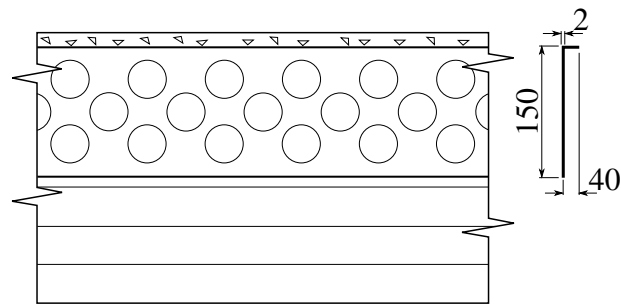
Connecteur plaque d’acier testé par Piazza et Ballerini [82] (dimensions en mm)
